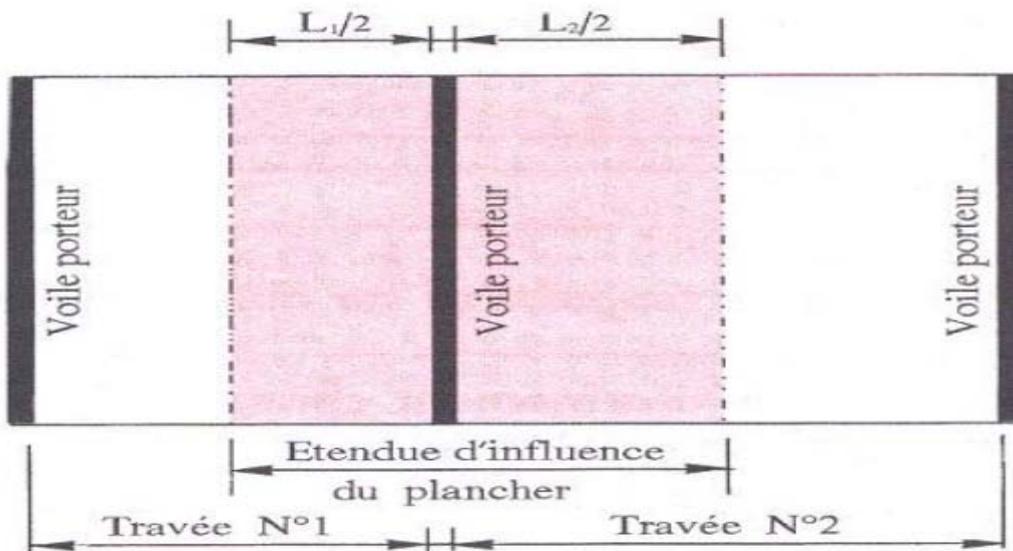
Etendue d'influence d'un plancher sur voiles porteurs parallèles.
